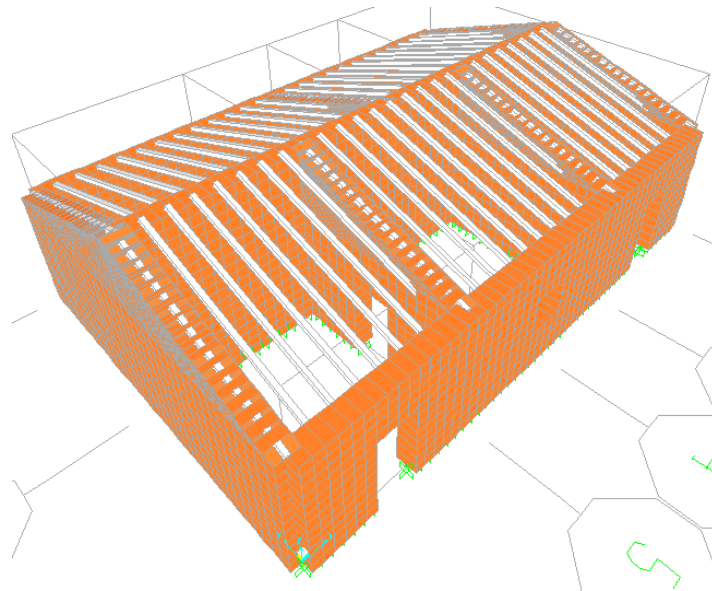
Modelo tridimensional da estrutura 4.2
